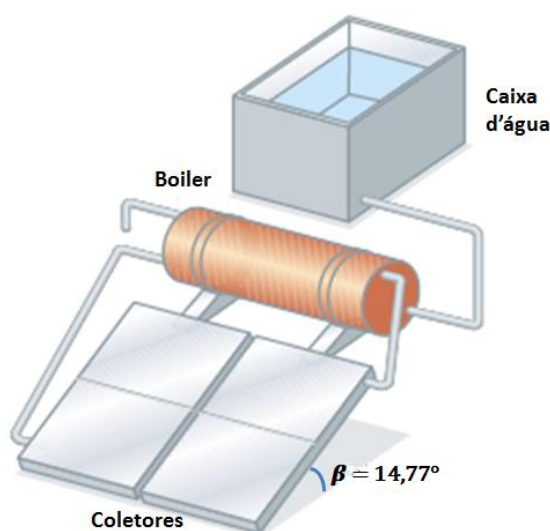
Conexão paralela dos coletores solares planos (ANEEL).
